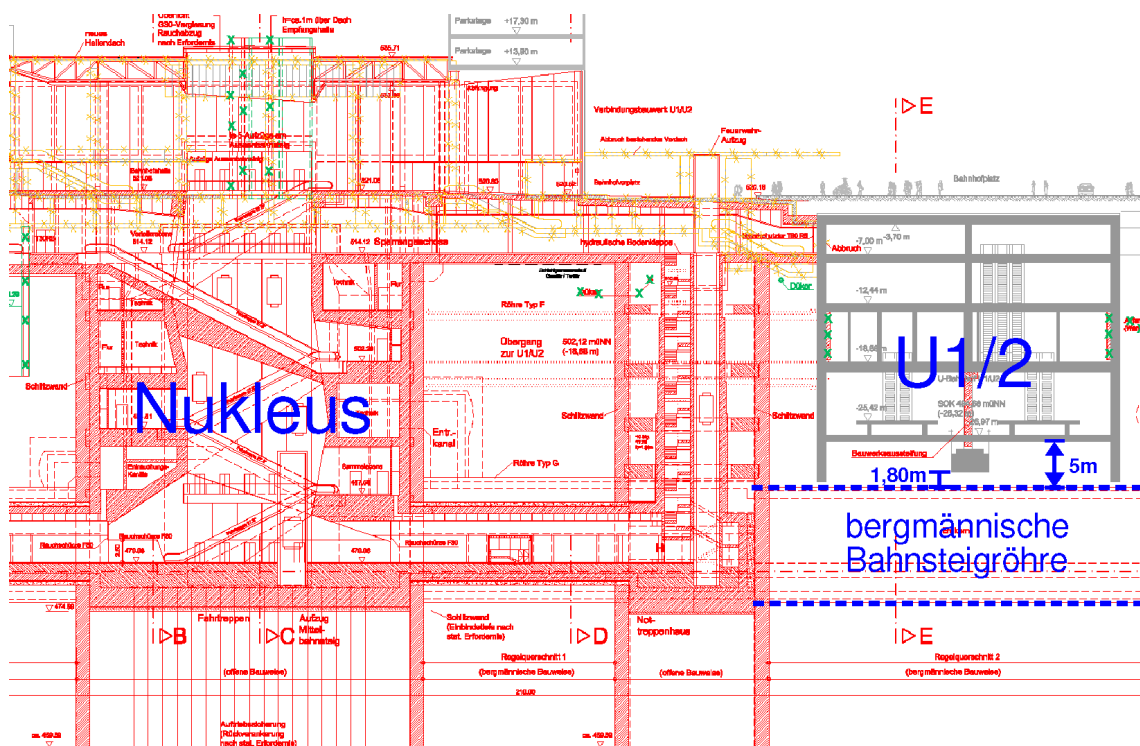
Bisherige Planung im Bereich Hauptbahnhof - Längsschnitt
